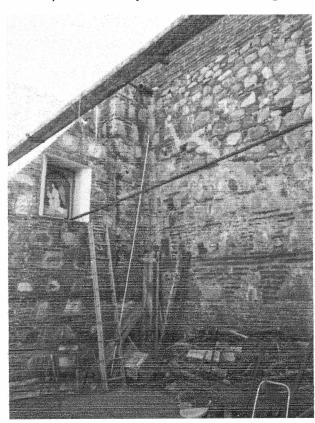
Muro de nave a un costado de la capilla anexa por el exterior
